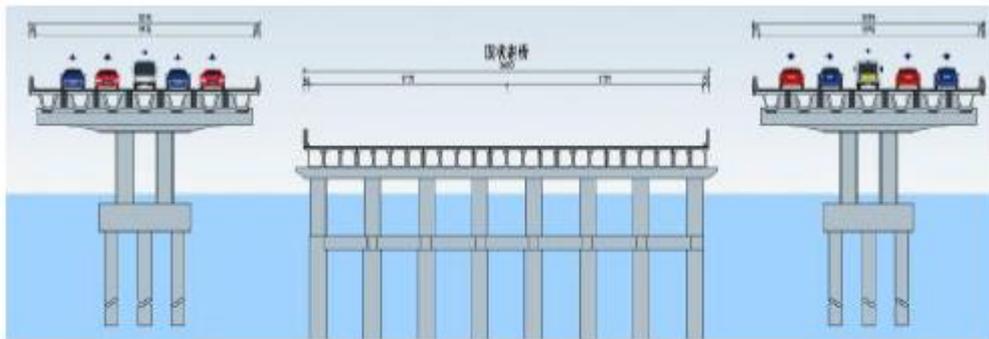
西环路跨新洋港、蟒蛇河标准横断面图
